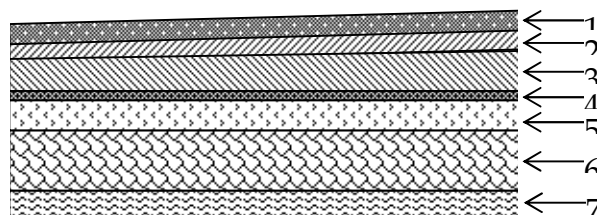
Coupe transversale du plancher terrasse inaccessible
